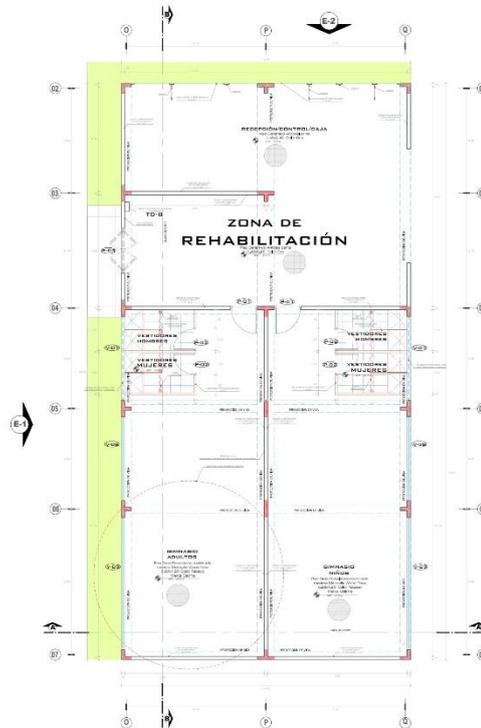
Planta proyecto - Bloque B – Zona de rehabilitación
